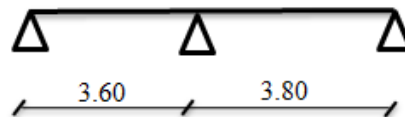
Poutrelle type 04 (Plancher RDC et étages courants)
